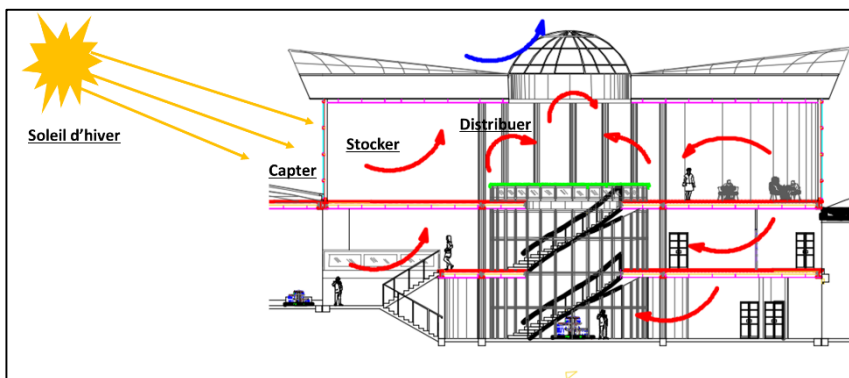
Ventilation naturelle au niveau de hall d'accueil en hiver source : hauteur
